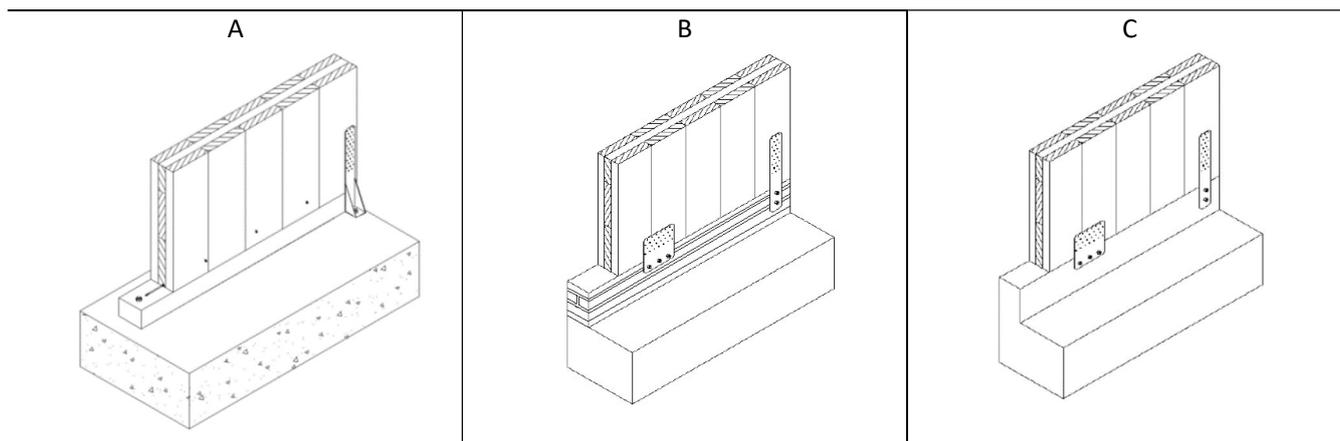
Soluzioni per il collegamento alle fondazioni. A collegamento con soglia in legno. B collegamento con soglia in acciaio o alluminio. C collegamento con cordolo di calcestruzzo
